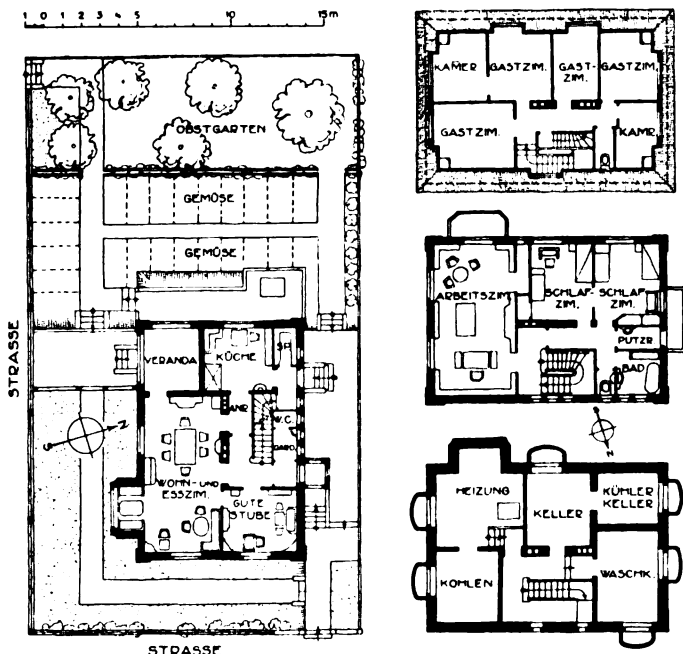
bis 4. Lageplan und Grundrisse 1:400 des Hauses K. Muthesius.
